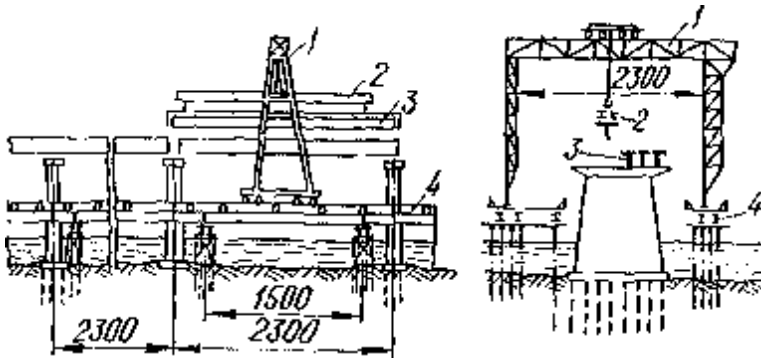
Схема монтажу балкової прогонової будови порталним краном:
